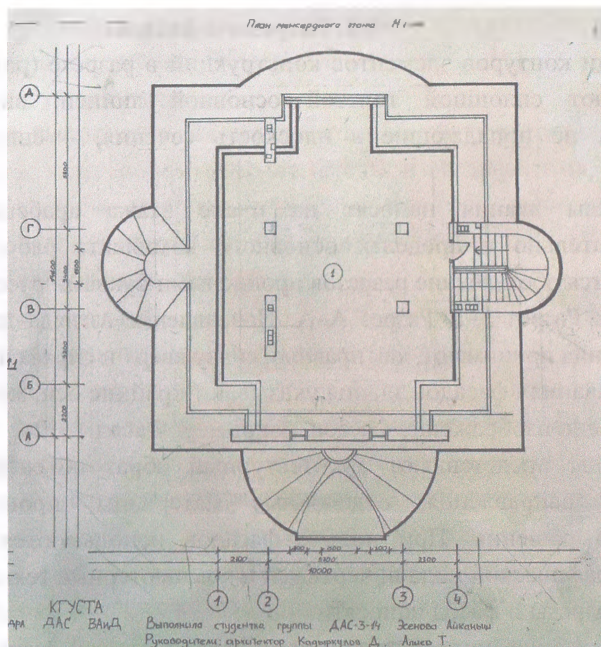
Планы жилого дома (фрагмент проекта студента гр. ДАС-3-14 Эсеновой Айканыш)
